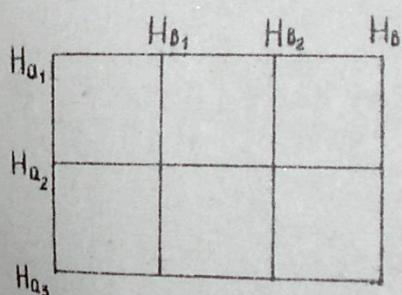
Проектирование горизонтальной площадки под условием нулевого баланса земляных работ
